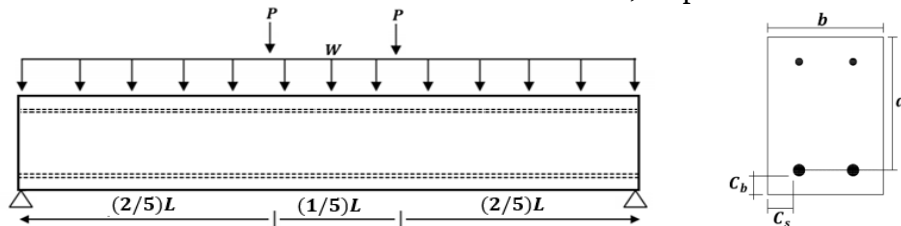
Carregamento e detalhamento transversal das vigas de Baroni (2003).
